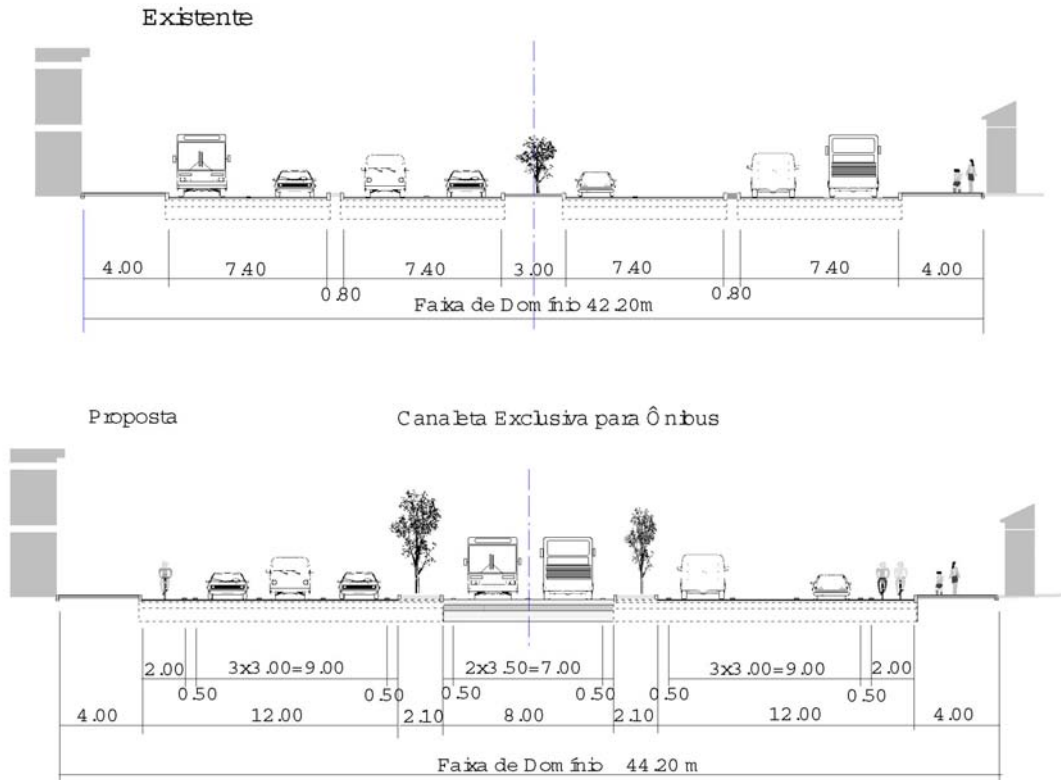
Seção Transversal da Avenida Almirante Barroso: Atual e Proposta
